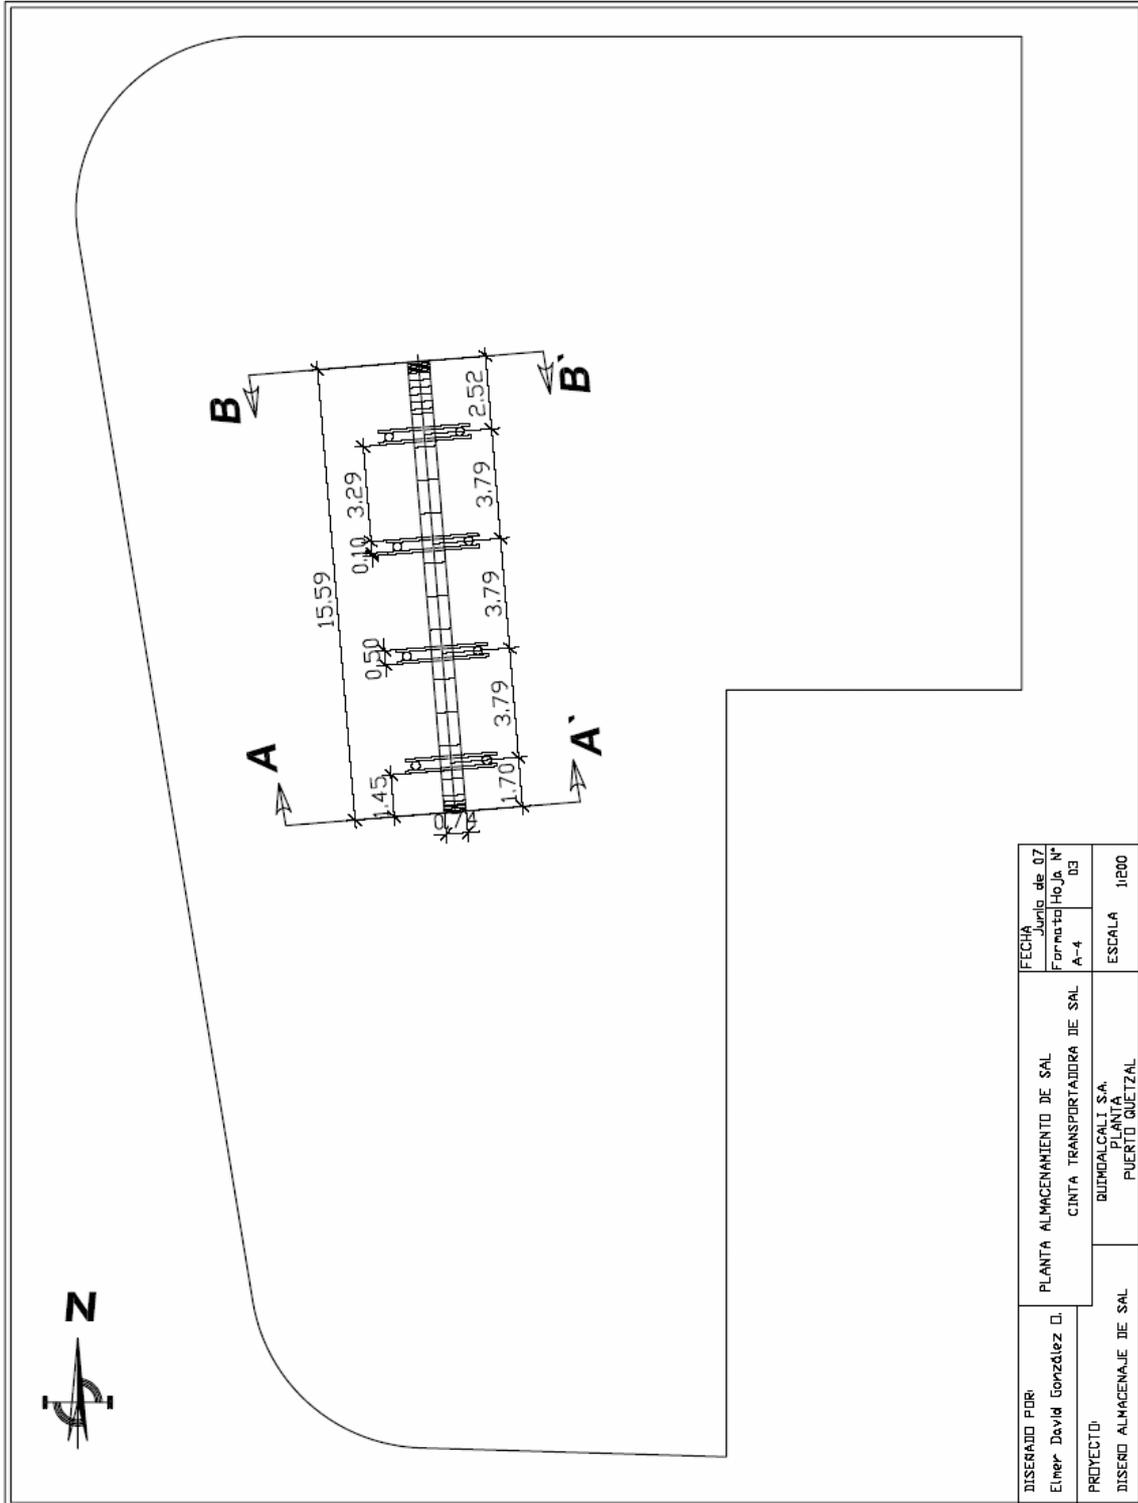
Vista de planta del corte de la sección B-B' a C-C'
